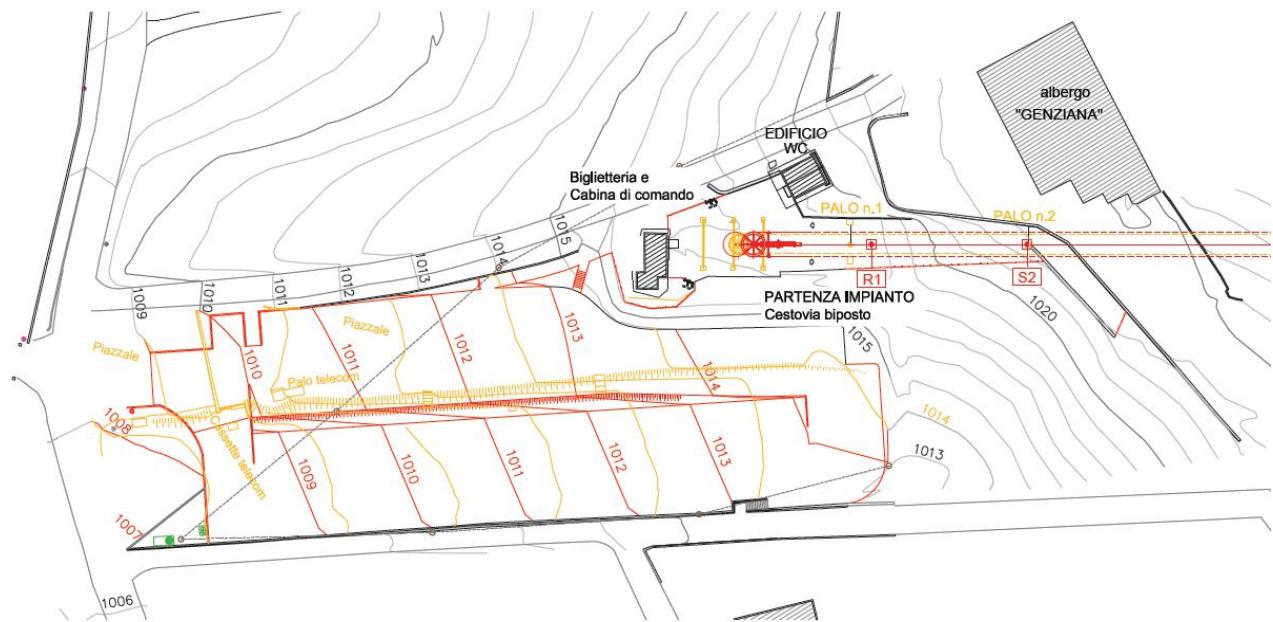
/III: Planimetrie dell'impianto "Prada - Costabella" particolare dello stato di progetto del parcheggio di valle
